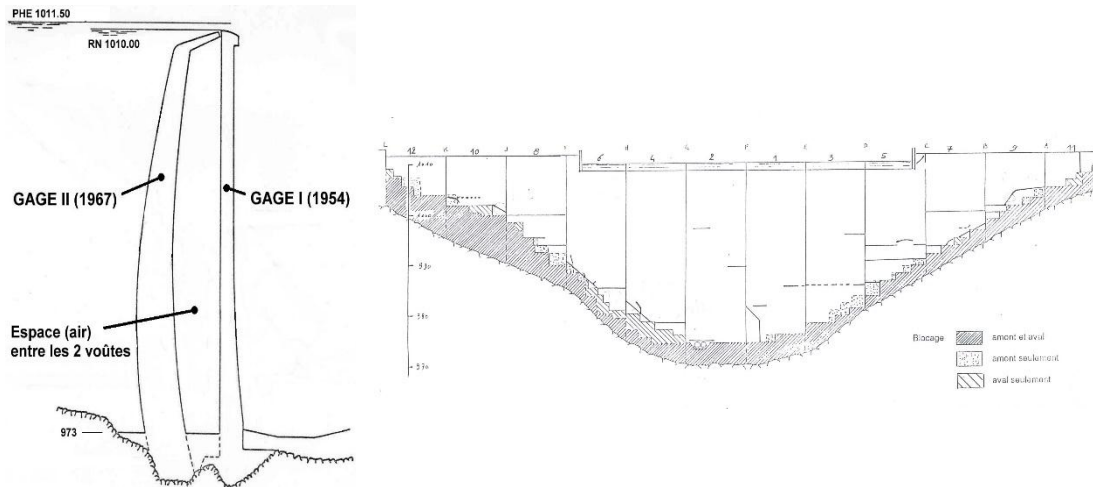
Barrage du Gage. Coupe en console centrale. Développement d'une fissuration en parement aval
